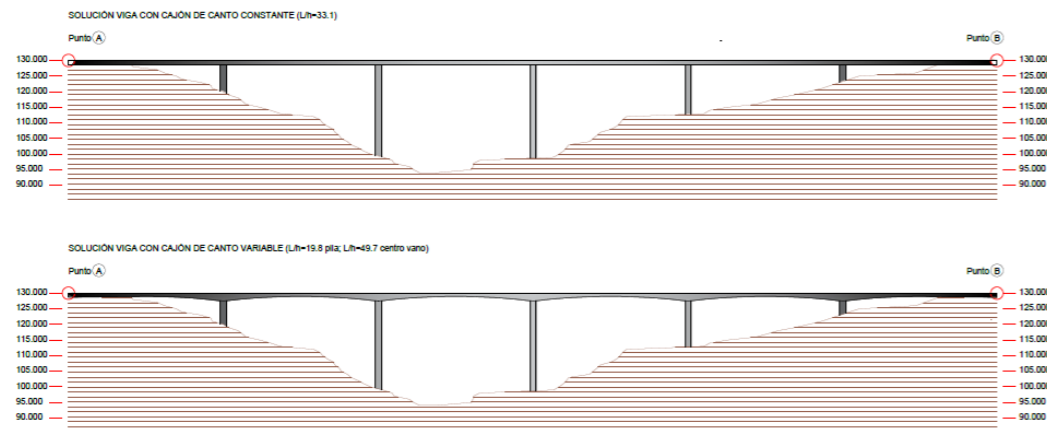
Alzado para soluciones viga en cajón de canto constante y canto variable. Fuente: Elaboración Propia (AutoCAD)
